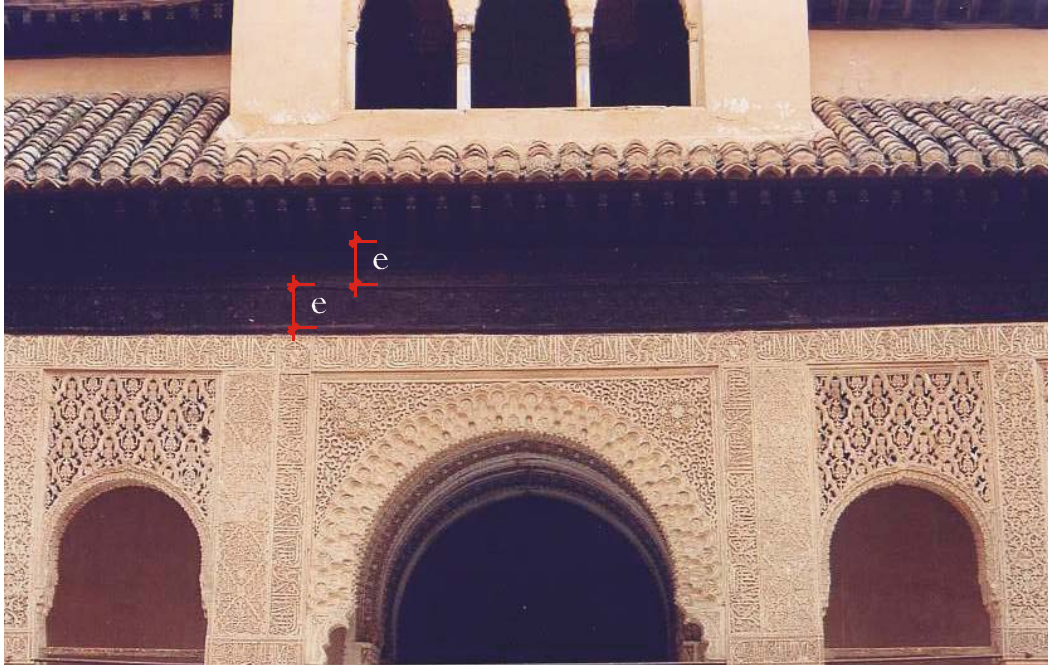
Revestimiento en madera dispuesto en el adintelado de fachada como tratamiento constructivo para ocultar la discontinuidad que provocan los forjados de galería y alero.
